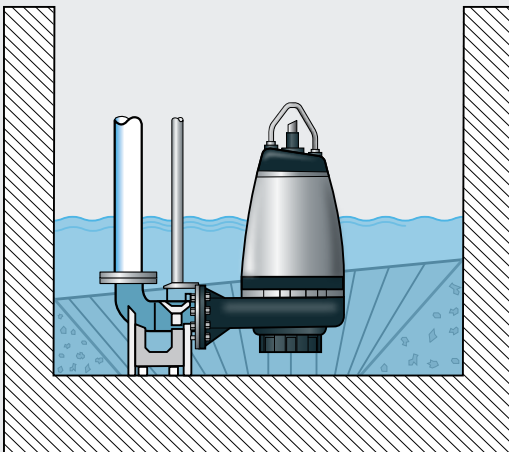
Tauchbare Installation auf Kupplungsfußkrümmer mit Führungsrohr
